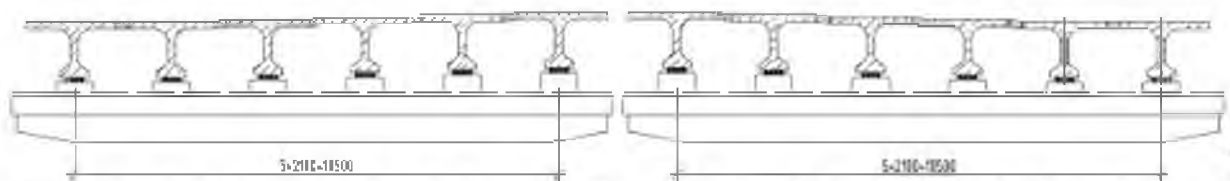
Схема розташування залізобетонних балок прогонувої будови автодорожнього мосту
